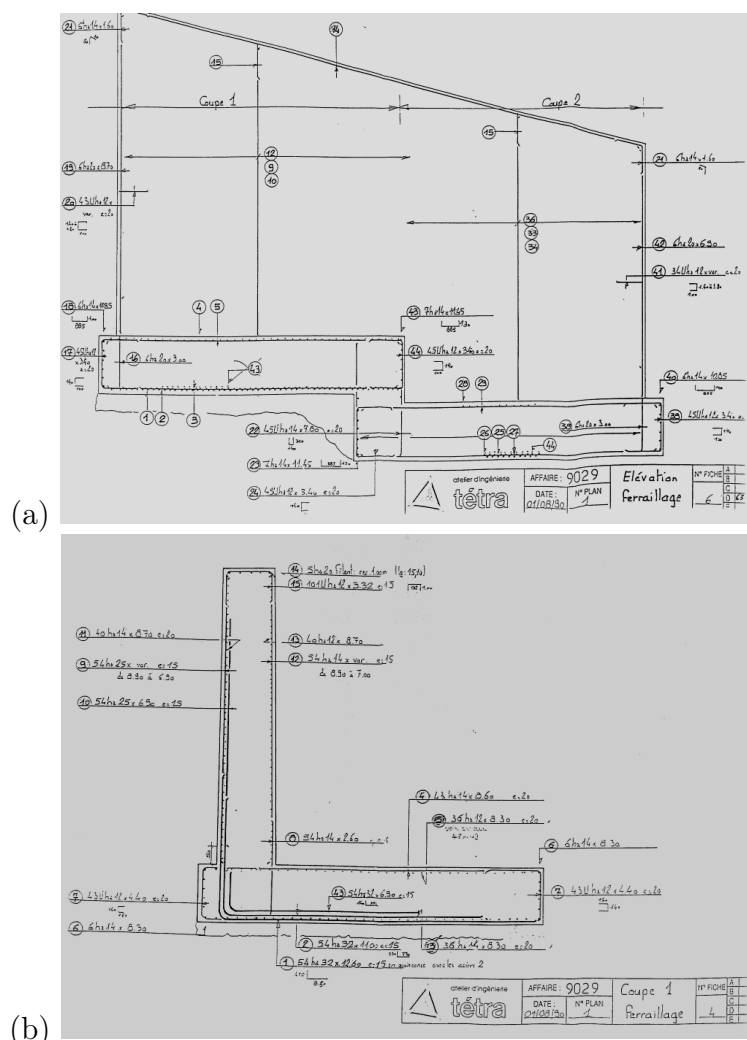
Plans de ferrailage des dents défectrices de Taconnaz : (a) en élévation et (b) en coupe
